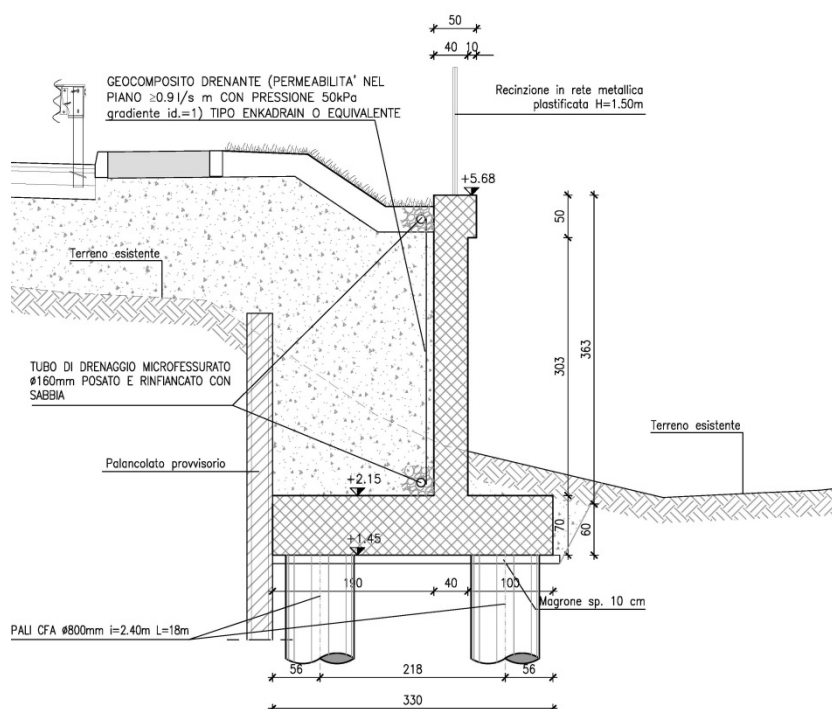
Muro di sostegno nord – Sezione trasversale
